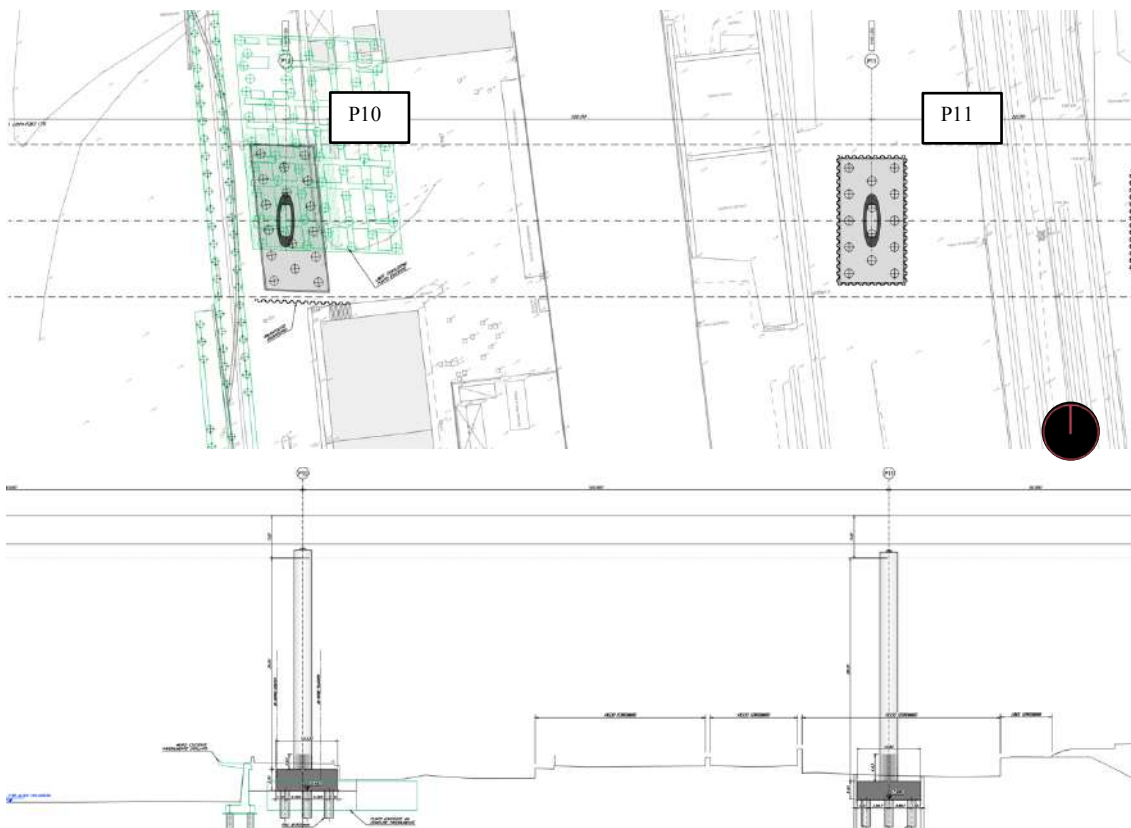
Planta e elevação lateral dos pilares elípticos P10, P11 e respectivas fundações. Fonte: Adaptada de ITALFERR
